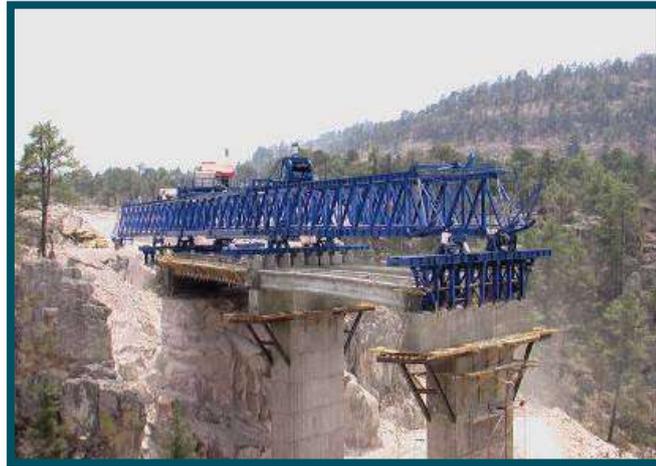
Tablero lanzado. Puente "Canoas" en Durango (SIP, 2009)
